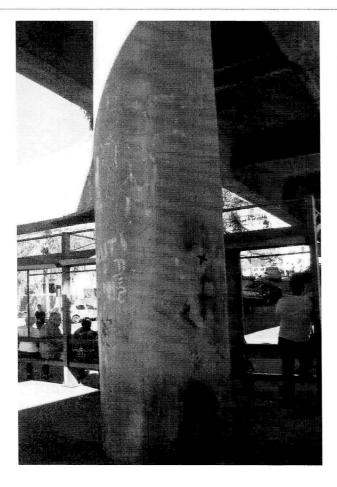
Detalhe de desplacamento de concreto e pequenas fissuras.
